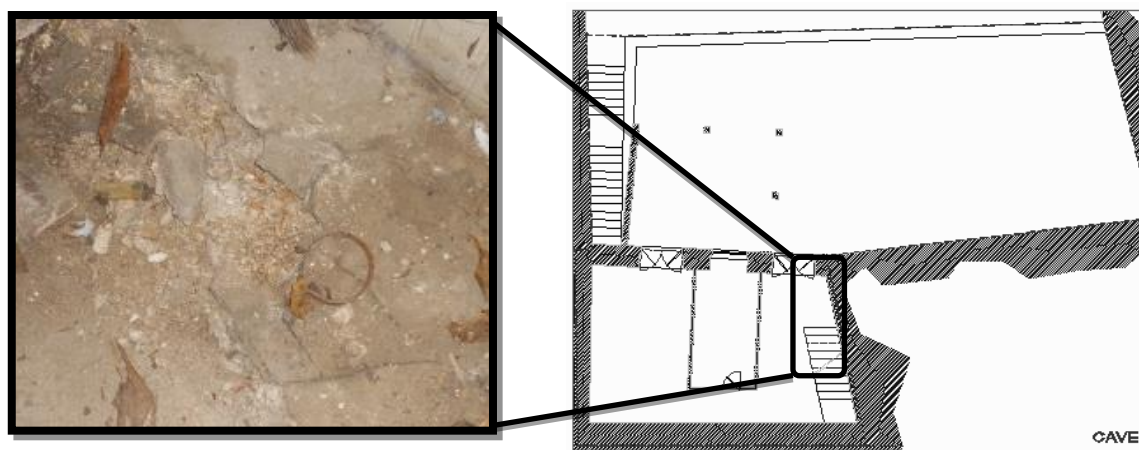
Anomalia 3 - Fotografia e localização em planta
